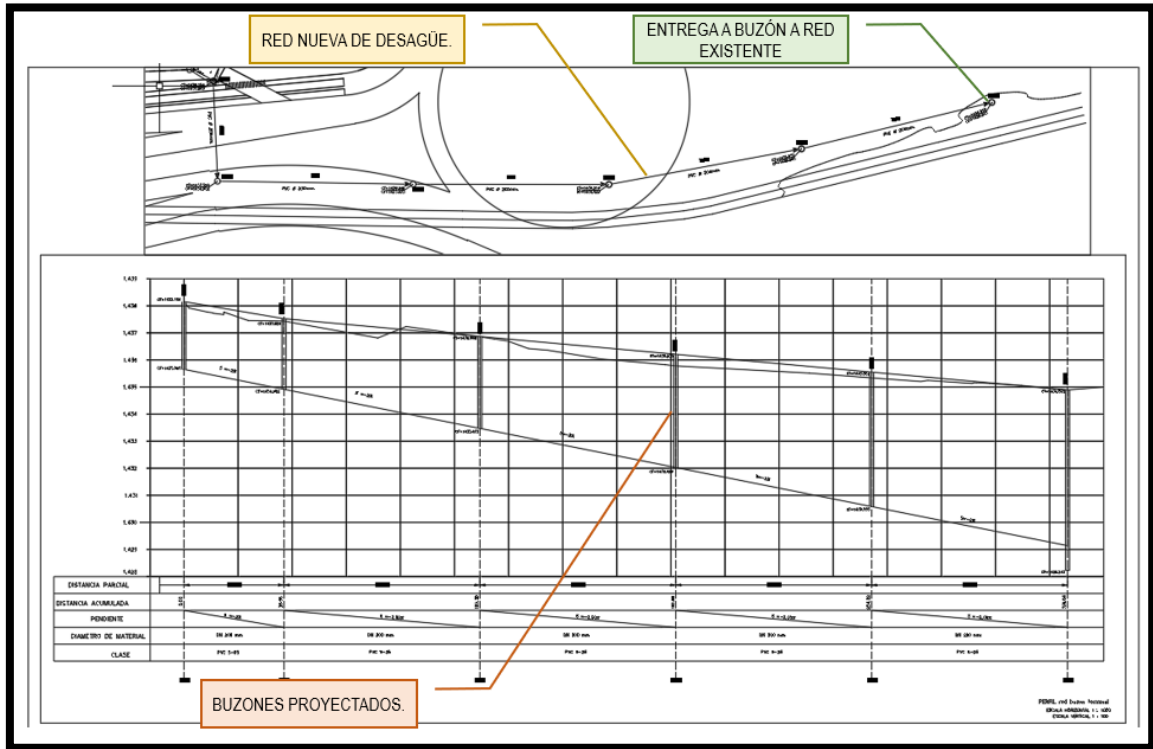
Plano de planta y perfil de nueva red de desagüe del proyecto hacia red existente.
